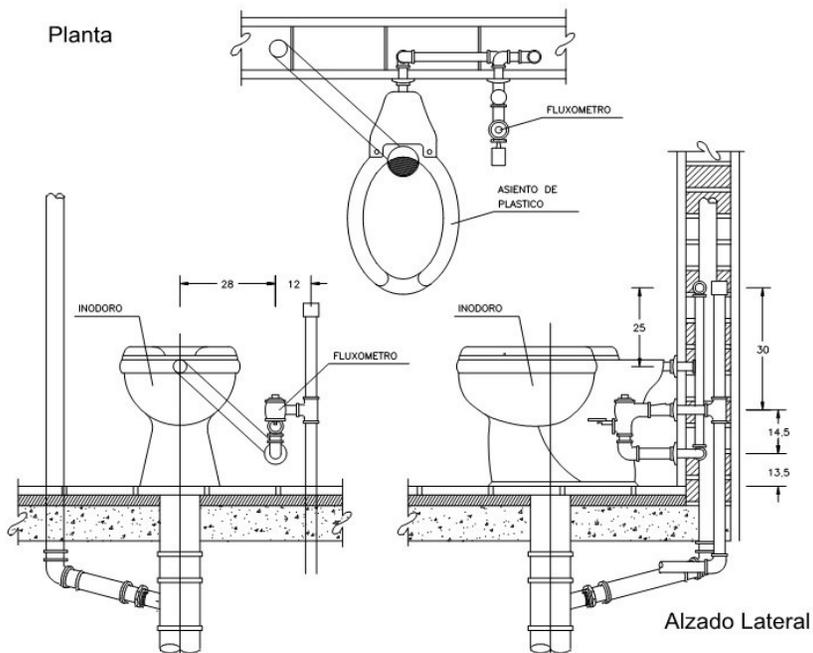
Detalle de baños / Fuente: Buscador de Arquitectura (arq.com.mx)
